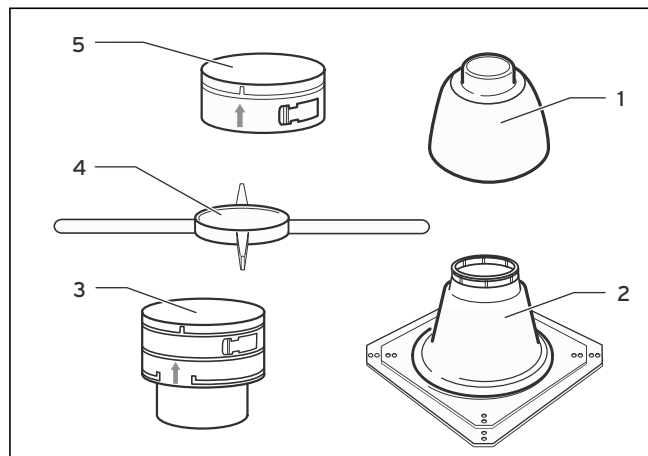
Гибкий выпускной газопровод, (набор 1 арт. № 303 510)
